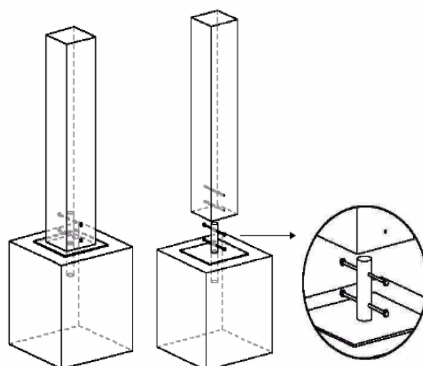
Fixação do Pilar. Fonte: maurovcruz
